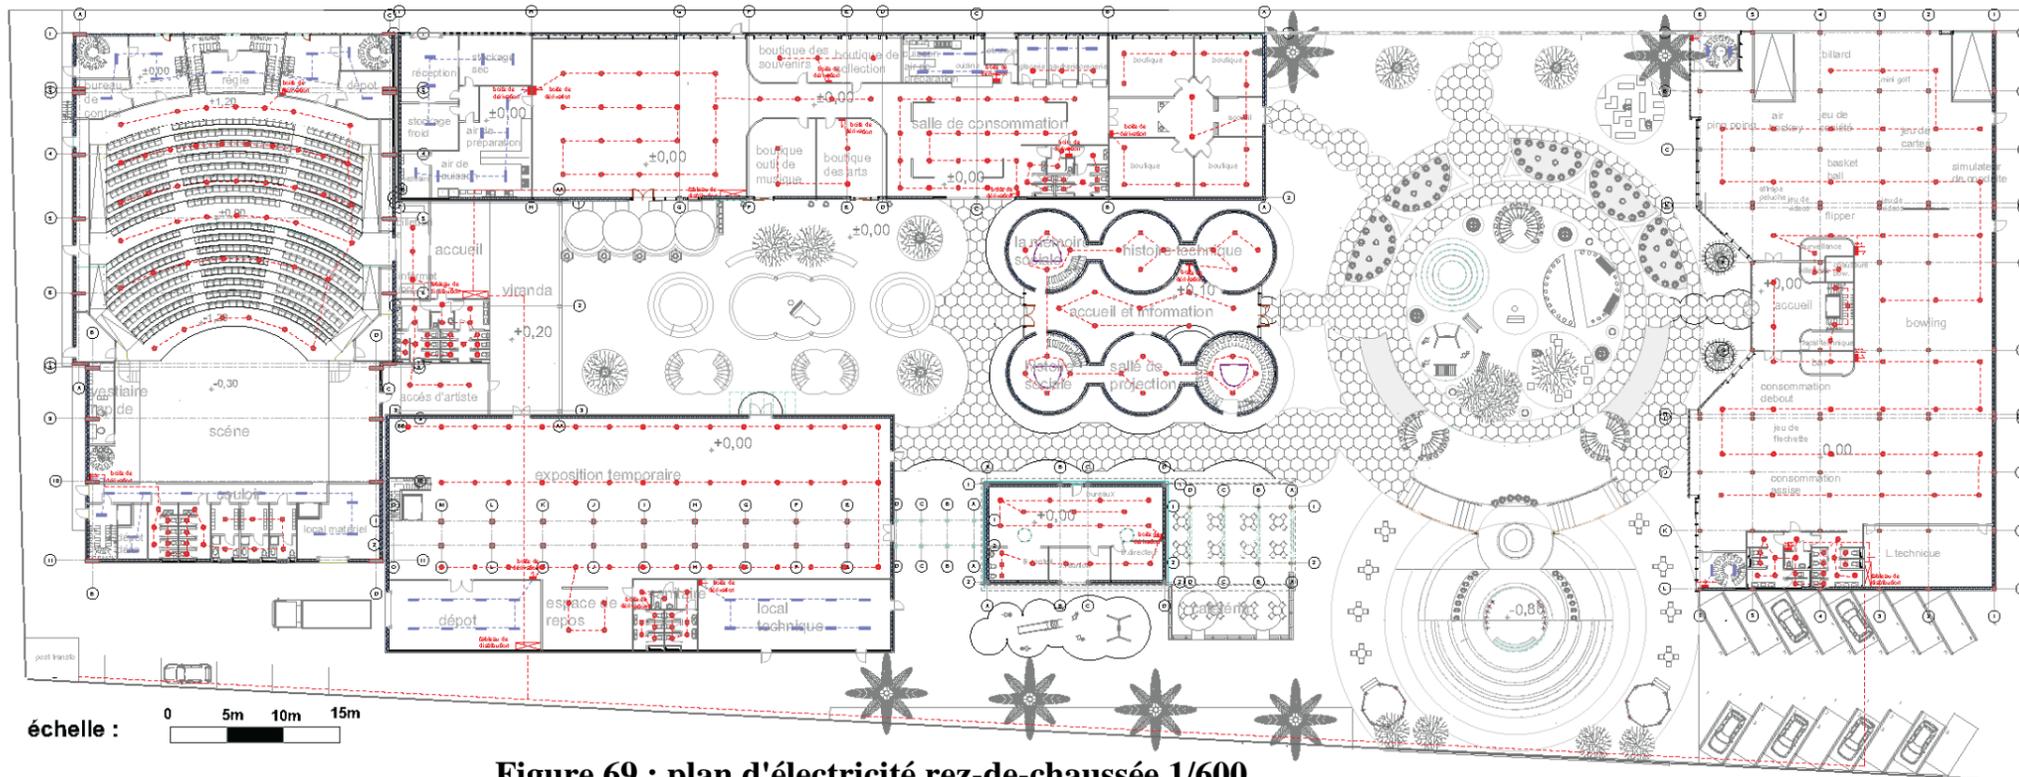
plan d'électricité rez-de-chaussée 1/600
